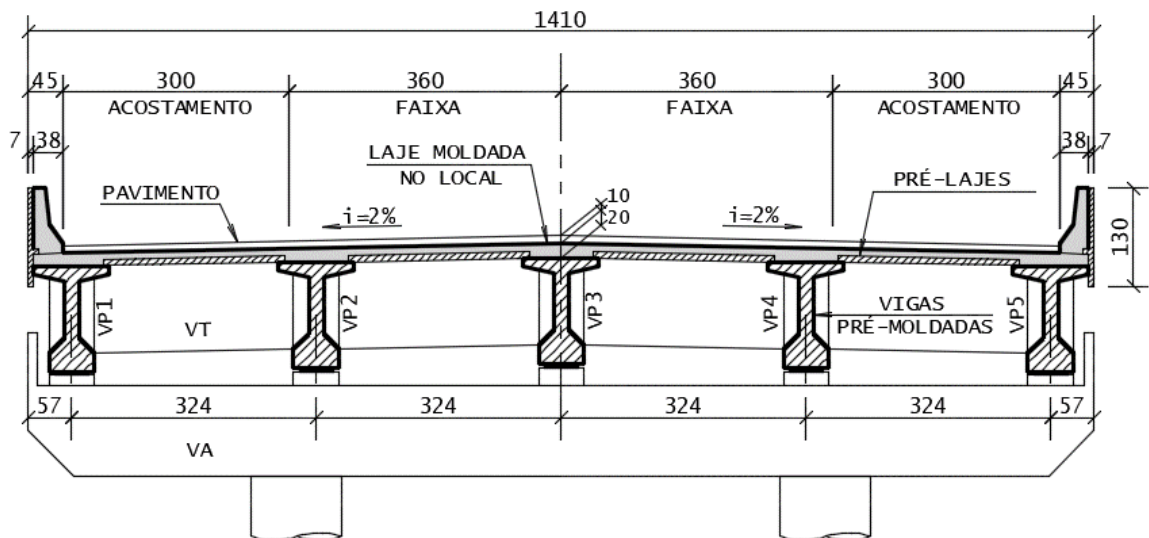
Planta da superestrutura do tabuleiro 14,10x25,00 m<sup>2</sup>
